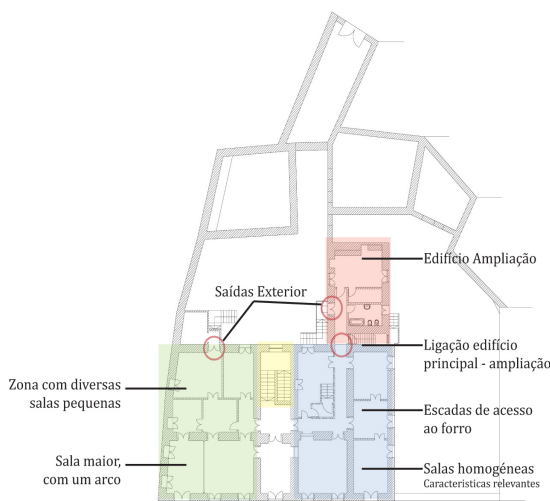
Planta original, Piso 1, com zonamento e identificação de locais relevantes
